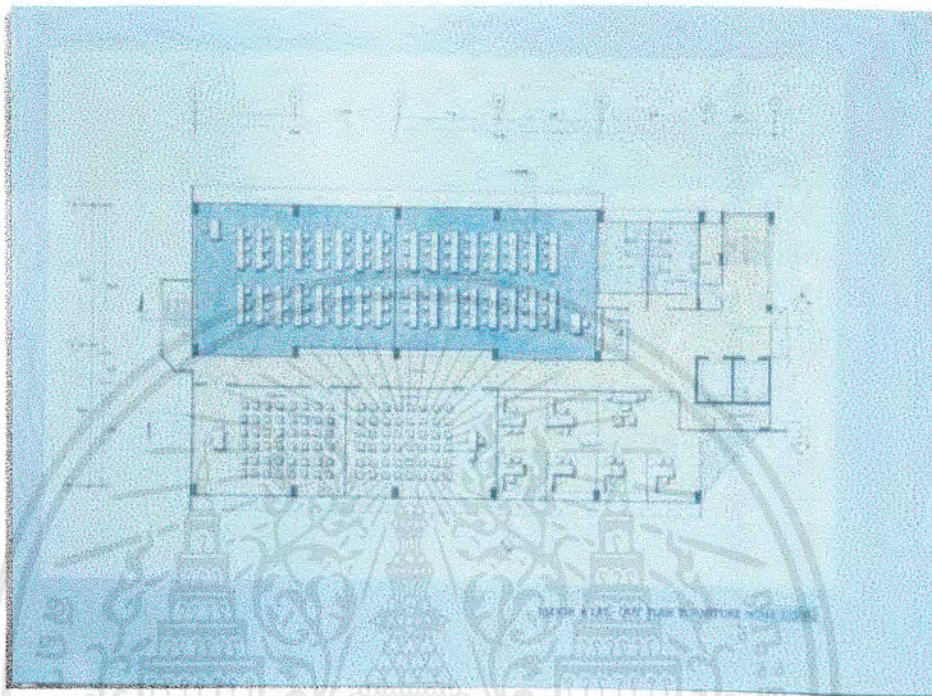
แสดง FLOOR 3 LAY-OUT FURNITURE PLAN
